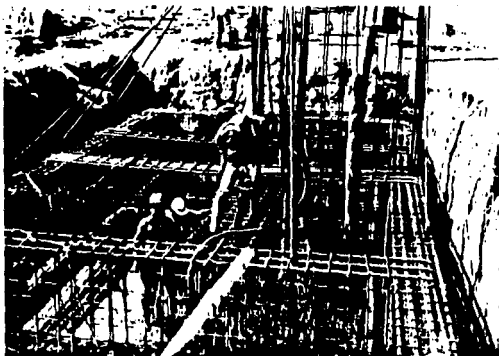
COLOCACION DEL ACERO EN LAS
